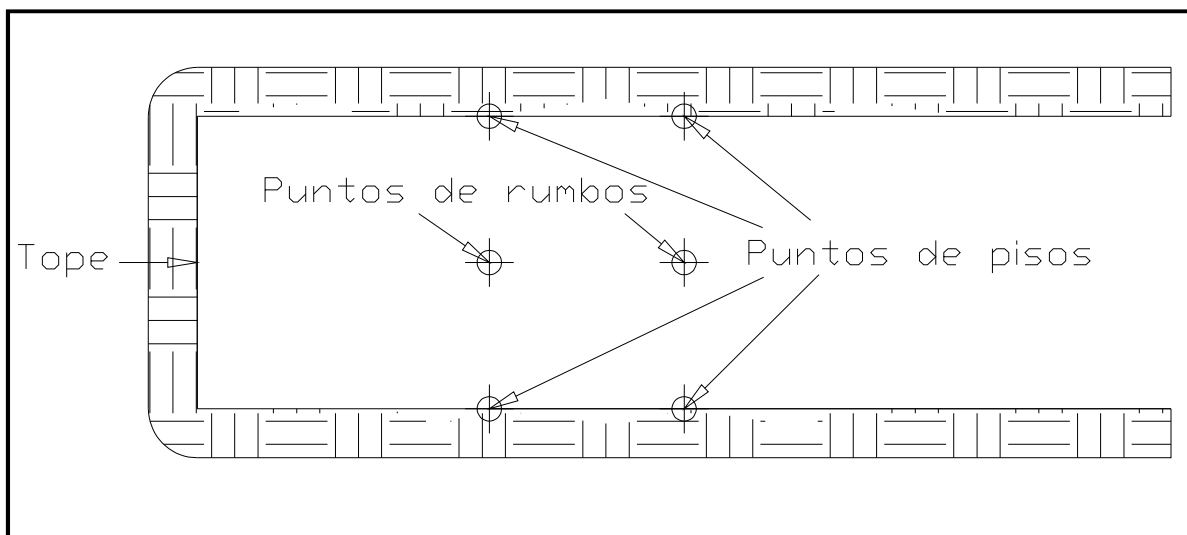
Vista de planta de una obra de 3.0 X 3.0 m.
